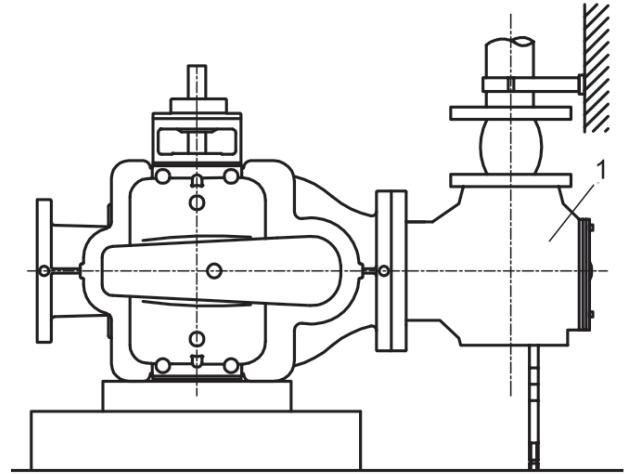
Рекомендованный монтаж всасывающего трубопровода и длина прямого трубопровода между горизонтальным коленом и насосом
